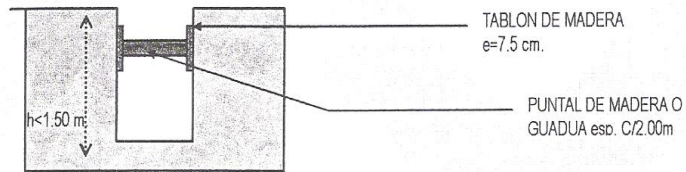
Apuntamiento excavaciones en zapatas y zanjas
